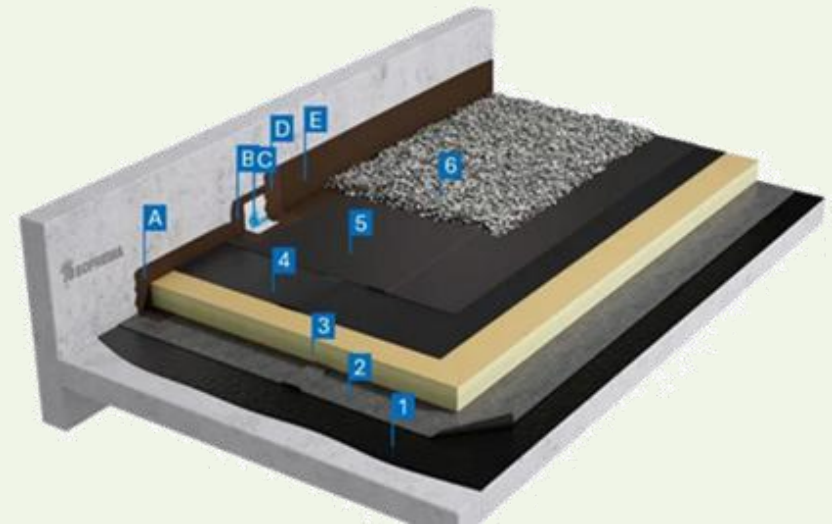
Isolation toiture terrasse (avec ou sans gravillon)
